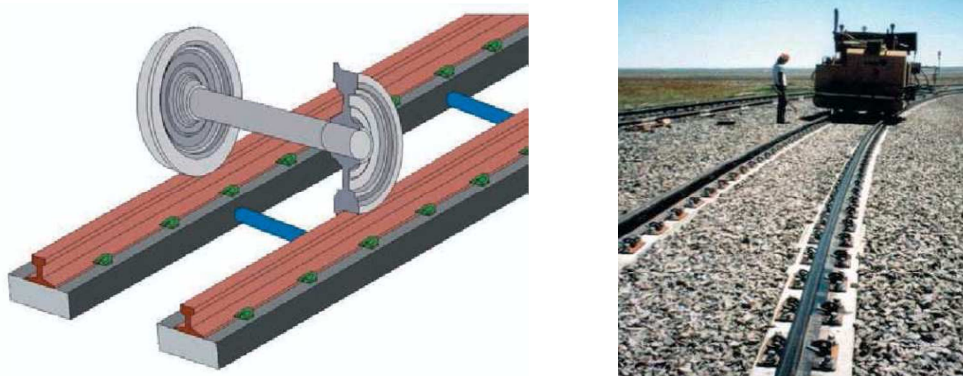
Contacto contínuo entre a travessa e o balastro, conferido pela solução Japonesa Ladder Trac [Paixão e Fortunato, 2010]
